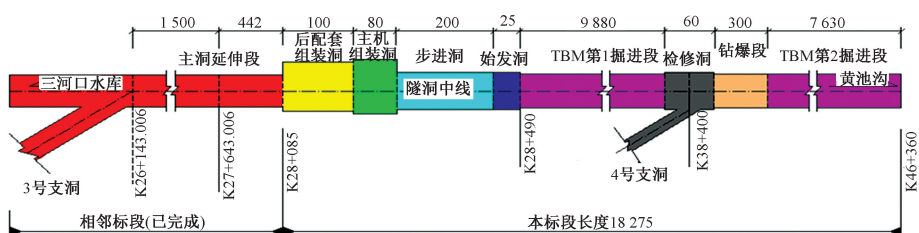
秦岭隧洞TBM施工段岭南工程平面布置(单位:m)
